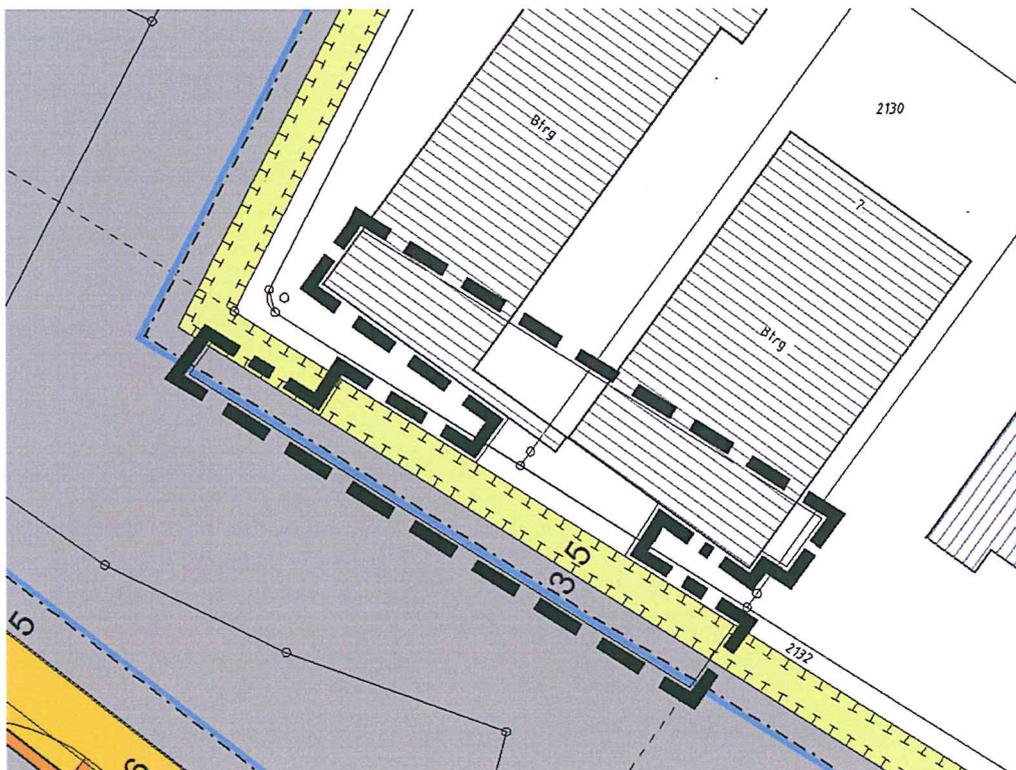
Geltungsbereich des Deckblatts mit geändertem Bebauungsplan „Im Grün II“
